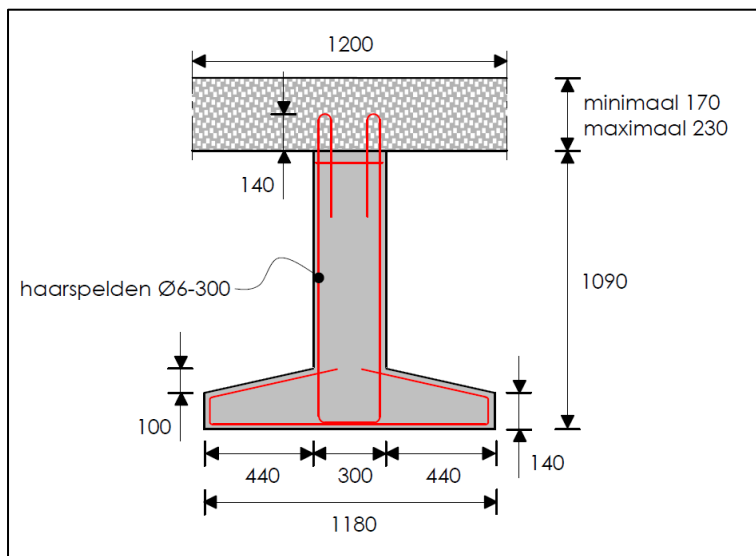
Doorsnede VVK-constructieopbouw in vergelijking tot betonnen druklaag
